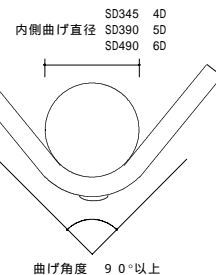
鉄筋の溶接性判定曲げ試験方法
